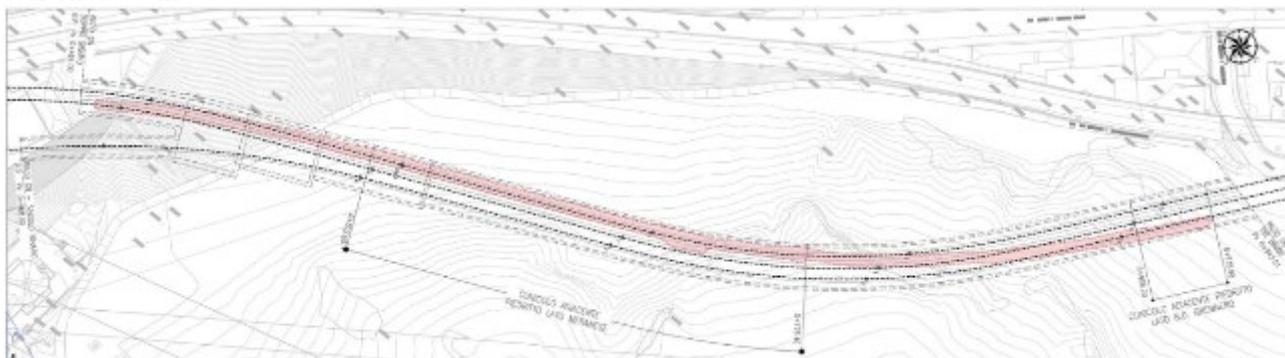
Galleria del Virgolo: planimetria con il cunicolo esplorativo
